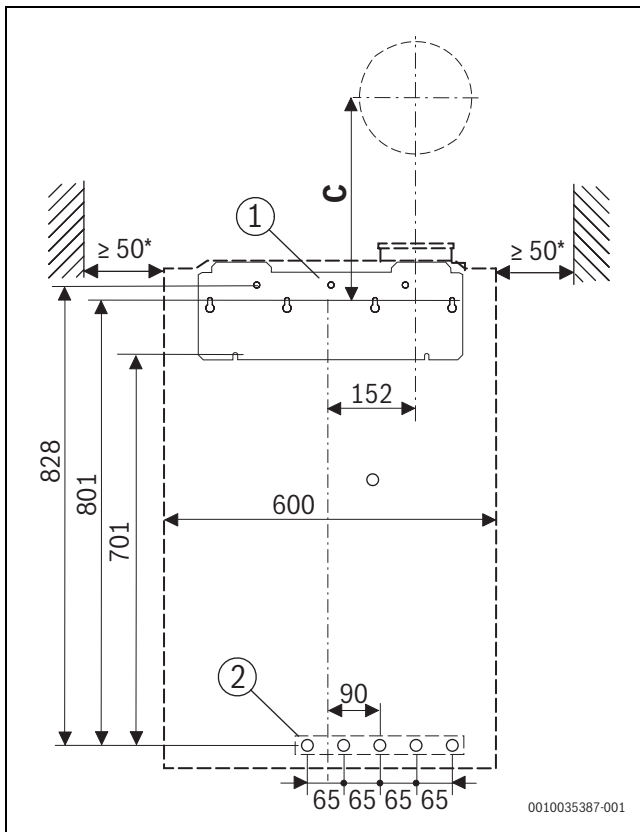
Vista frontal, ligação hidráulica horizontal(mm)
